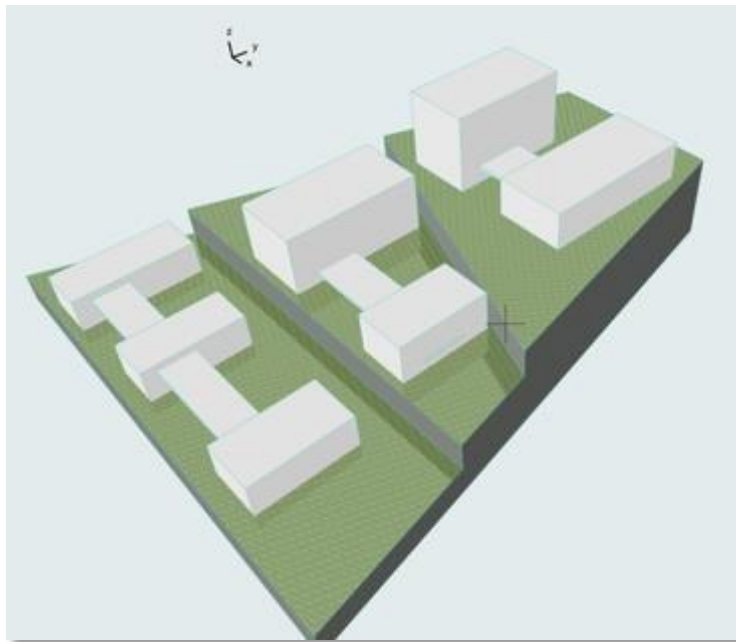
Esquema en perspectiva de propuesta arquitectónica - Elaboración propia
